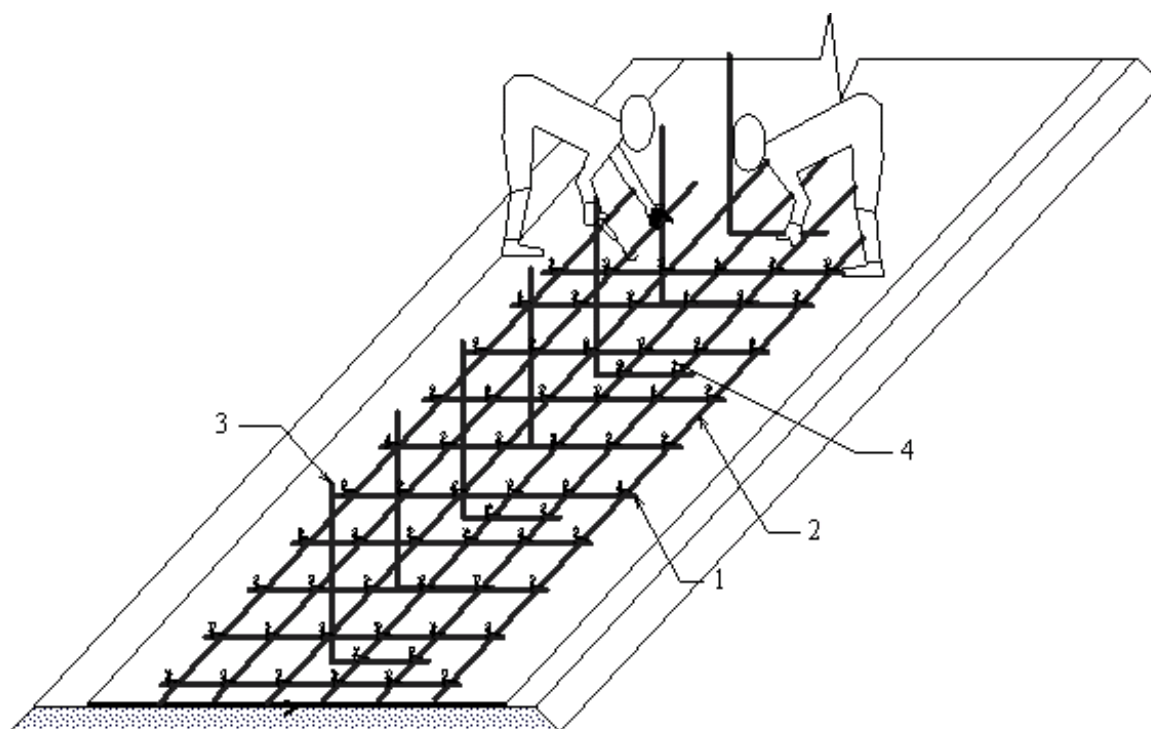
Установка и закрепление арматурных выпусков: 1 – поперечный стержень; 2 – продольный стержень; 3 – арматурный выпуск; 4 – закрепление арматурного выпуска к арматурной сетке вязальной проволокой
